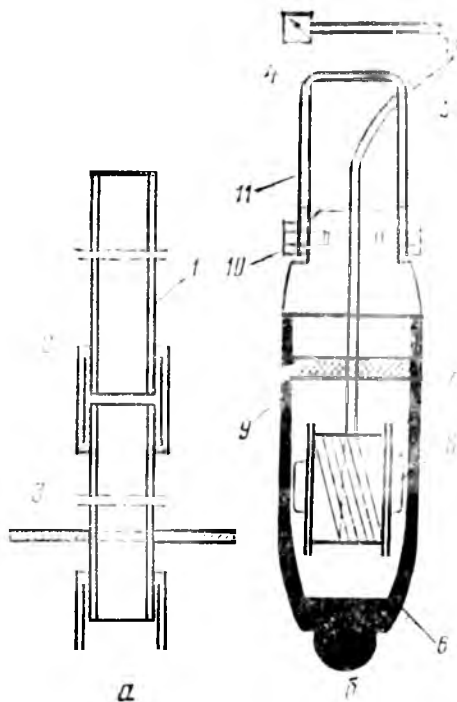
Глубинная электромагнитная марка: а — общий вид; б — устройство зонда; 1 — секция пластмассовой трубы; 2 — соединительный патрубок; 3 — металлическая пластина; 4 — гальванометр; 5 — кабель; 6 — корпус зонда; 7 — обмотка; 8 — магнит; 9 — крышка; 10 — болт; 11 — подвеска для троса.
